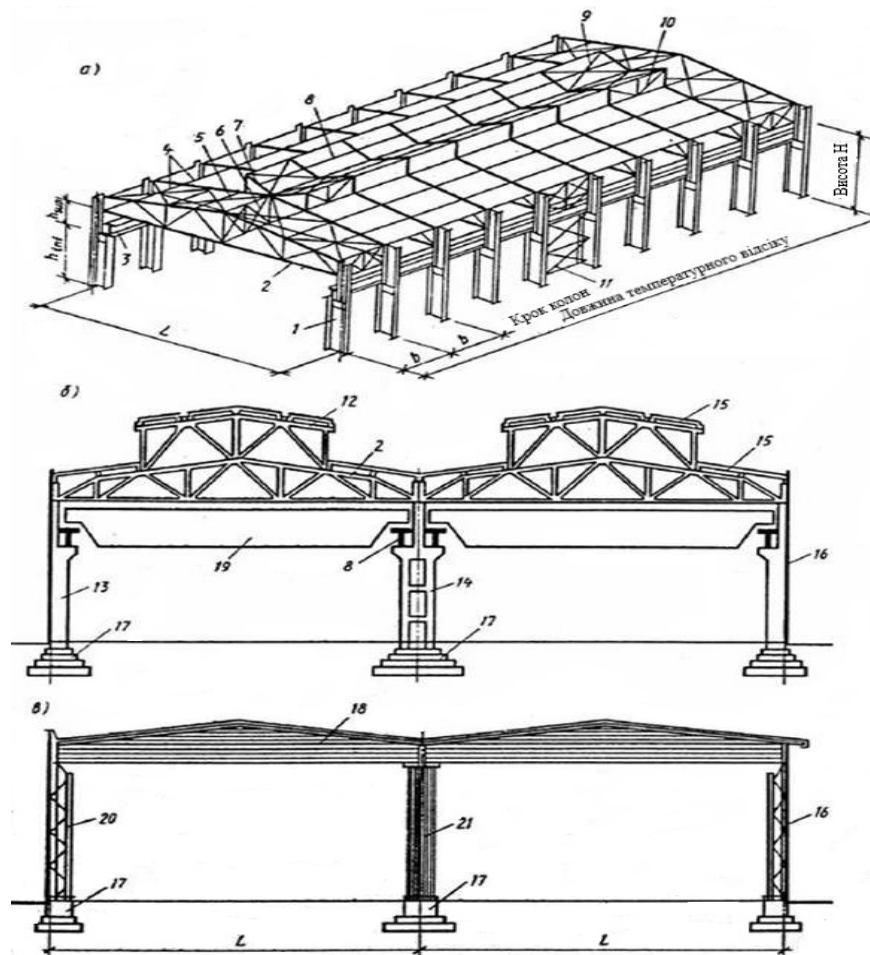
Конструктивна схема каркаса одноповерхової промислової будівлі,
